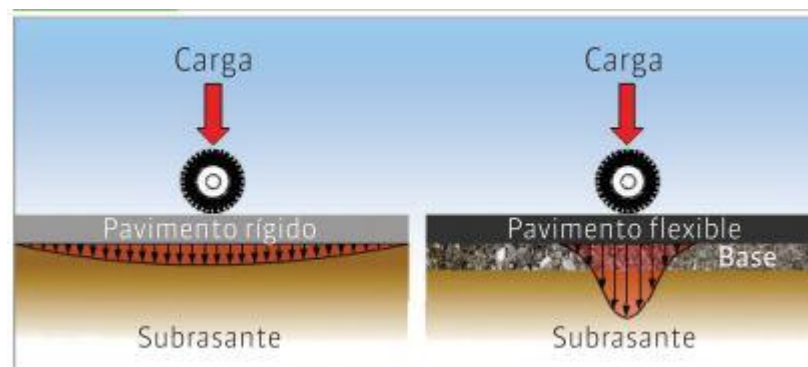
Distribución de cargas en un pavimento rígido y flexible. Fuente: ICPA 2014
